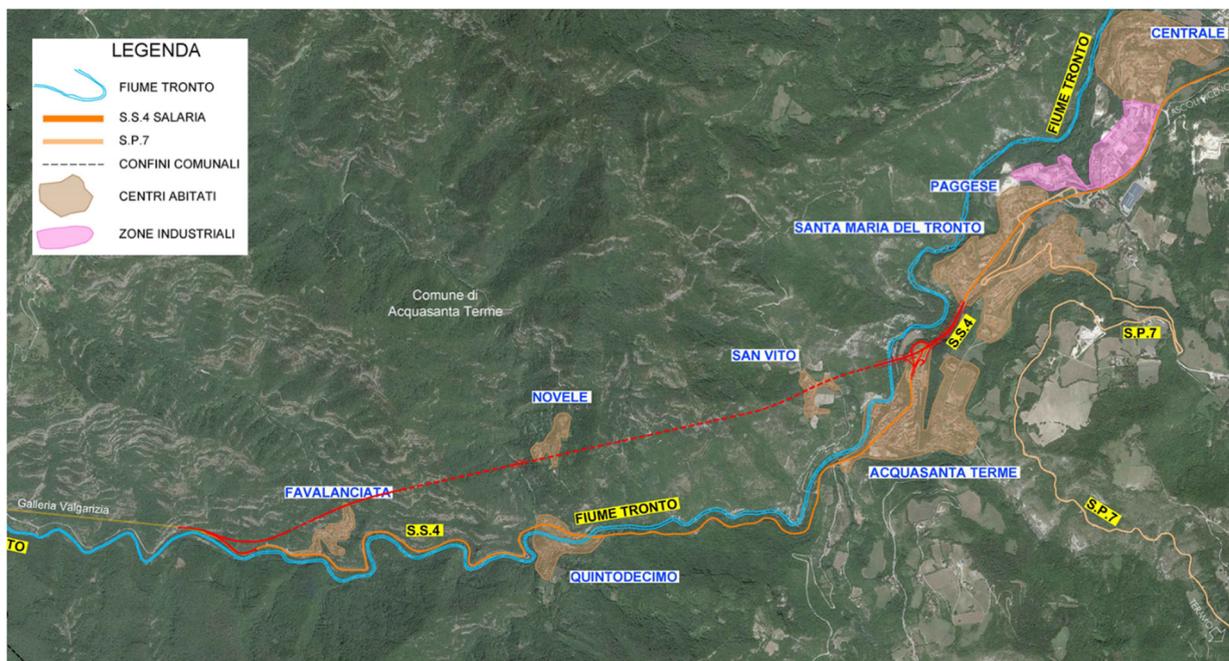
Alternativa 1 - Planimetria su fotomosaico
